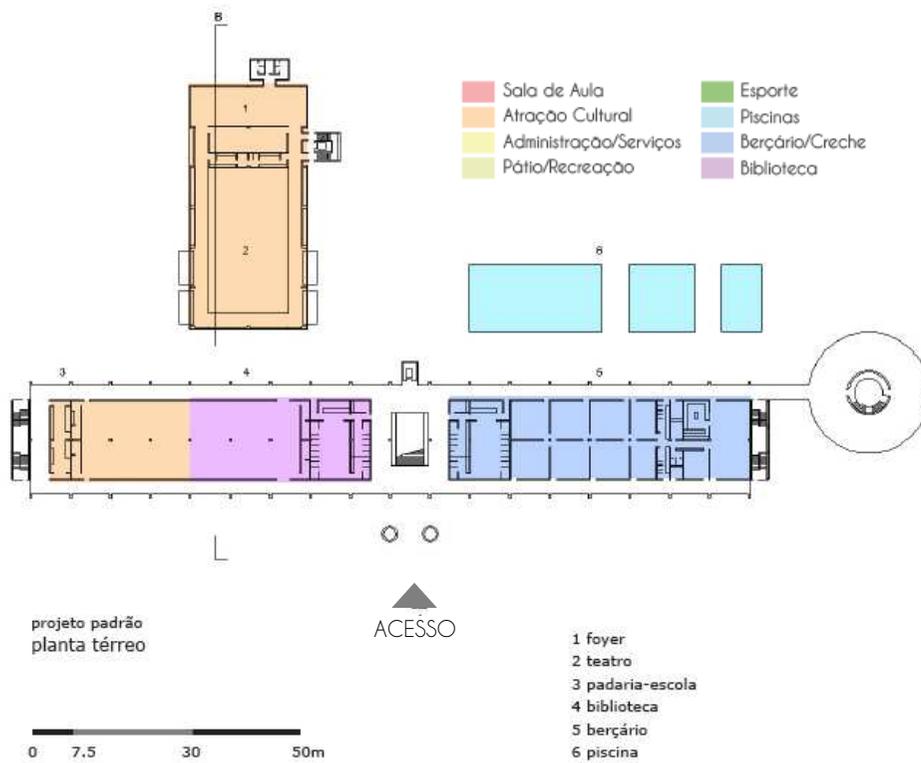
Projeto padrão CEUs - planta térreo. Fonte: Wilderom, 2014, p. 121, editado pela autora.
